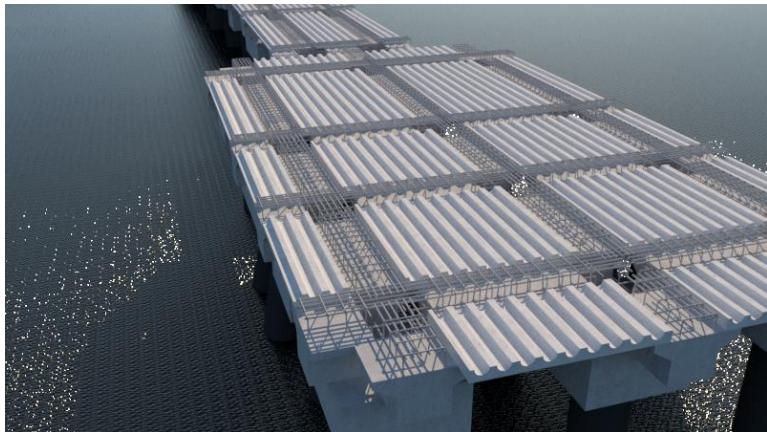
Ilustrasi Pemasangan Balok Precast
